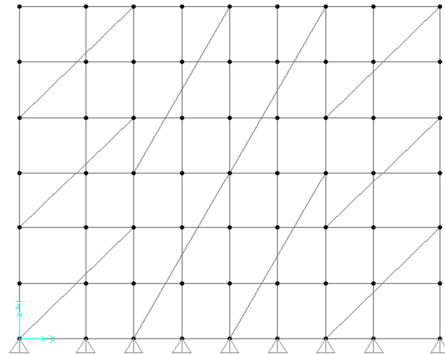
Configuração dos Planos de Contraventamento Vertical Com Elementos de Contraventamento Grandes
